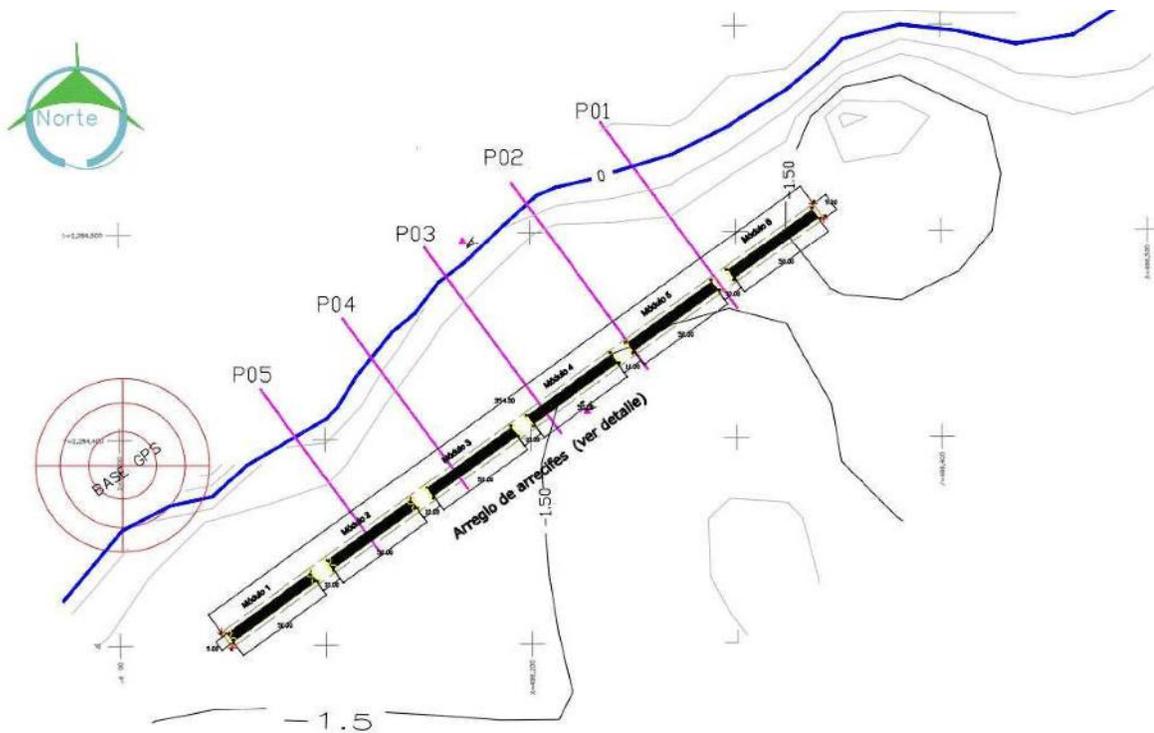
Planta general de ubicación de arrecifes artificiales
